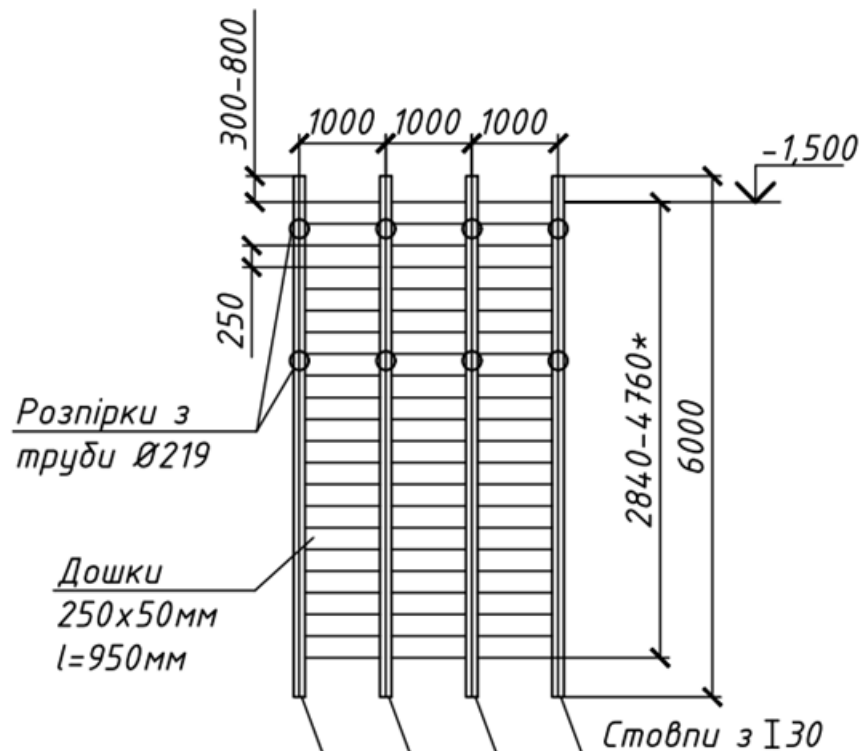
Схема кріплення стінок траншеї дошками.
